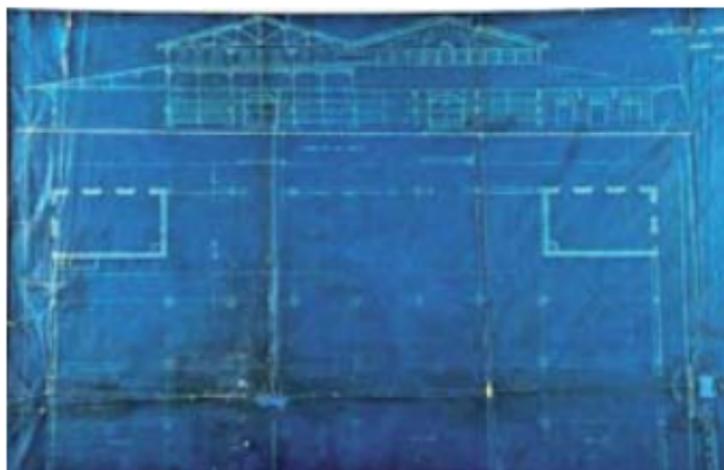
Plan original del mercado Pino Suárez de Mazatlán, 1896. Planta y alzado
